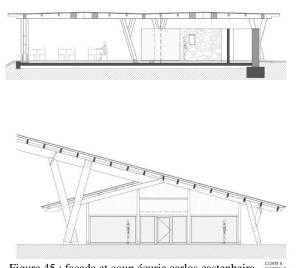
façade et coup écurie carlos castenheira SECTION B
